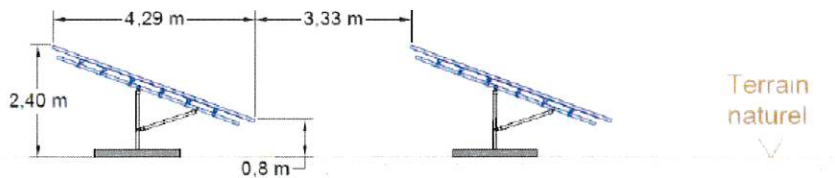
coupe transversale de principe des tables accueillant les modules photovoltaïques
